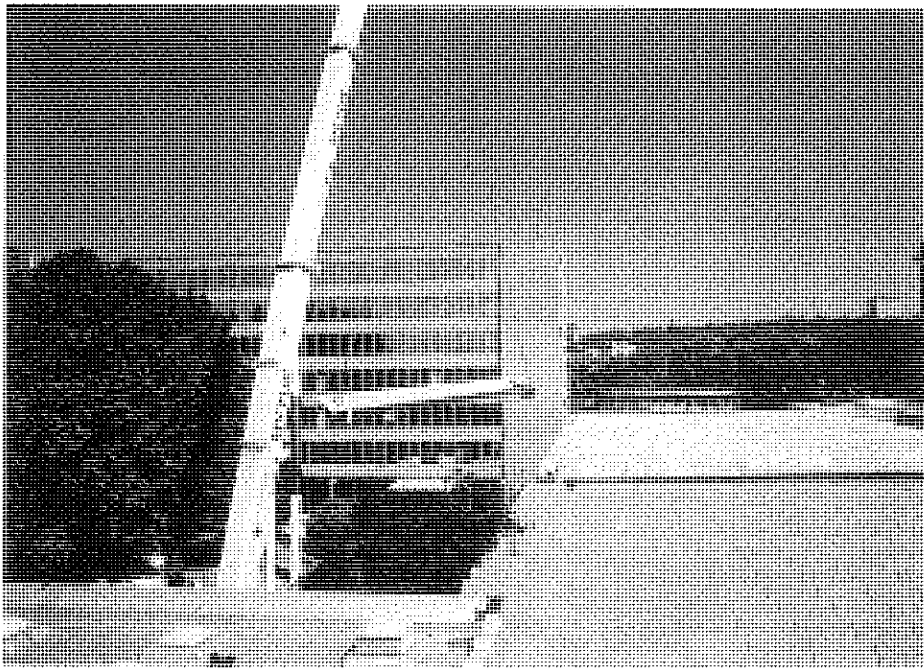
Vista superior de la cubierta durante la sustitución. Puede apreciarse la ligera pendiente transversal (longitudinal a las vigas) que se dió en la nueva cubierta.
